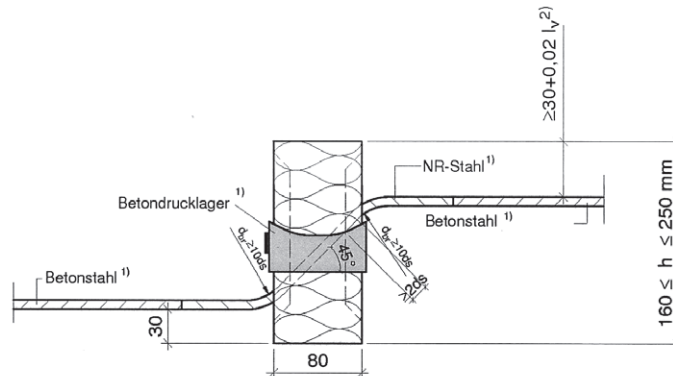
Beispiel Schöck Isokorb Typ RQ-240 mit Betondrucklager
